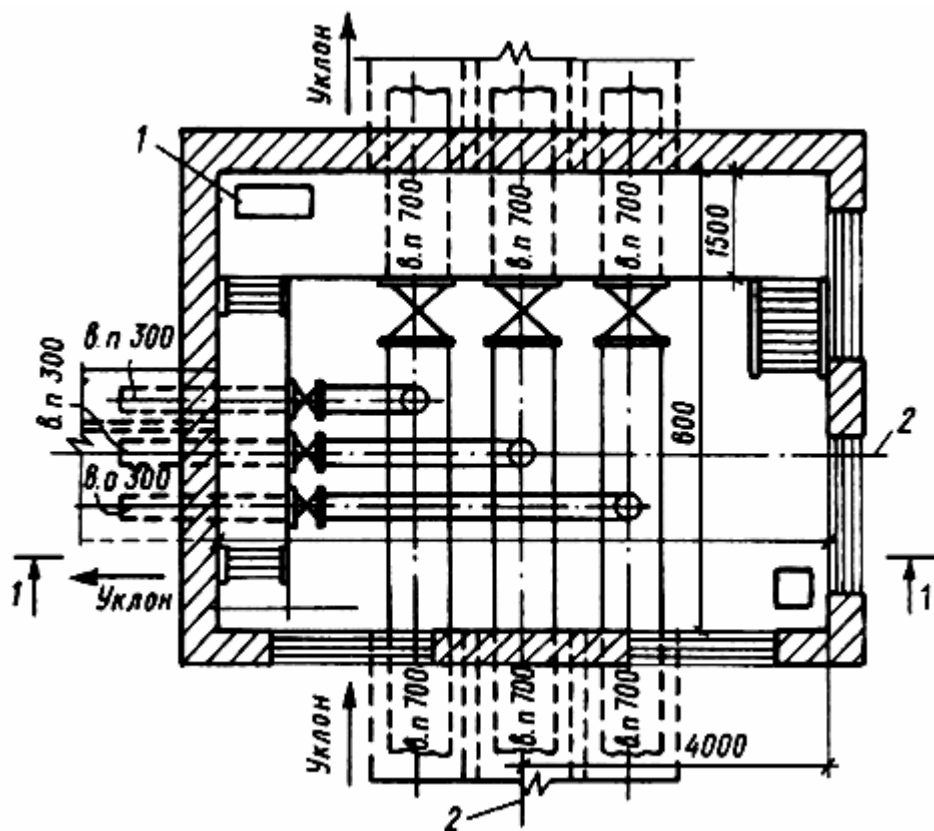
Надземный павильон узла установки задвижек с электроприводом на трехтрубном теплопроводе (план)
